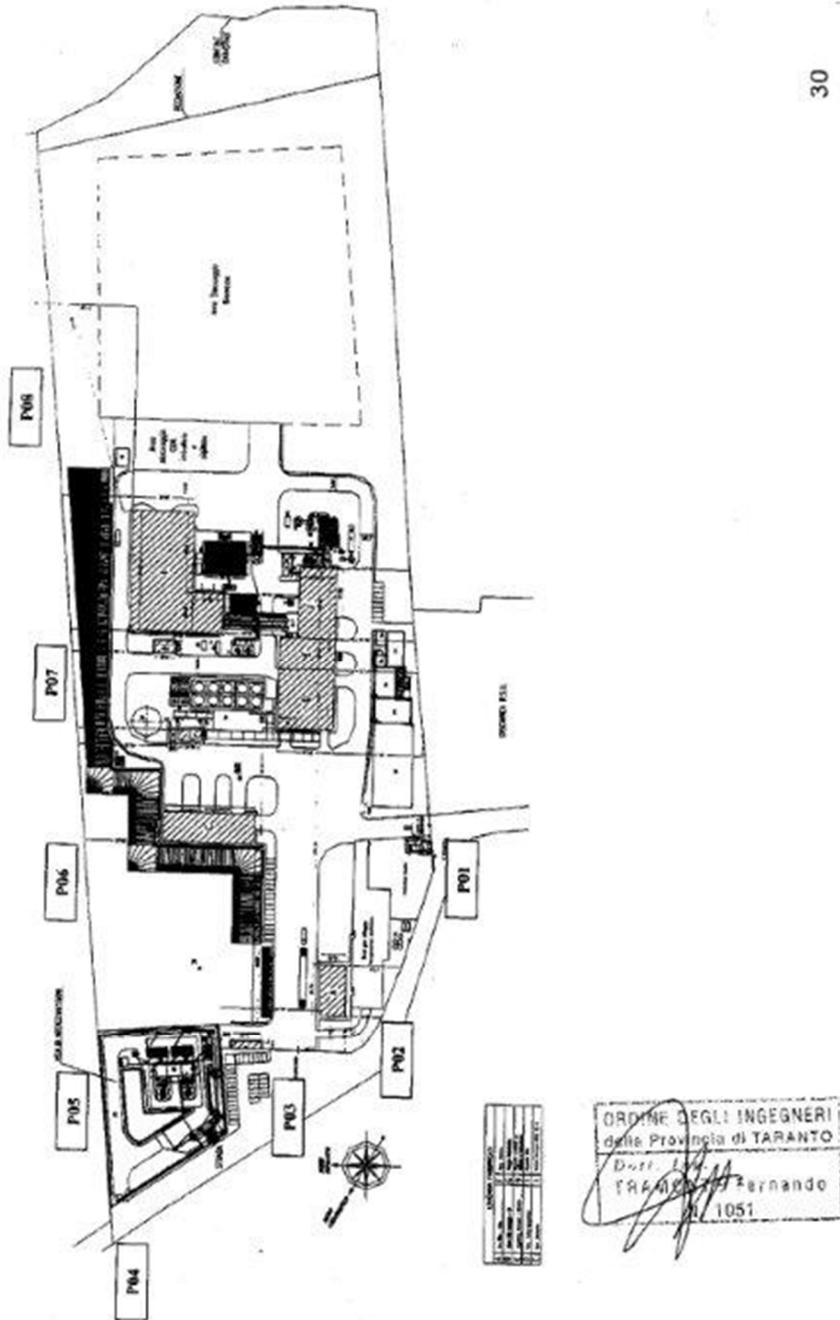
Planimetria punti di misurazione Rumore Esterno
